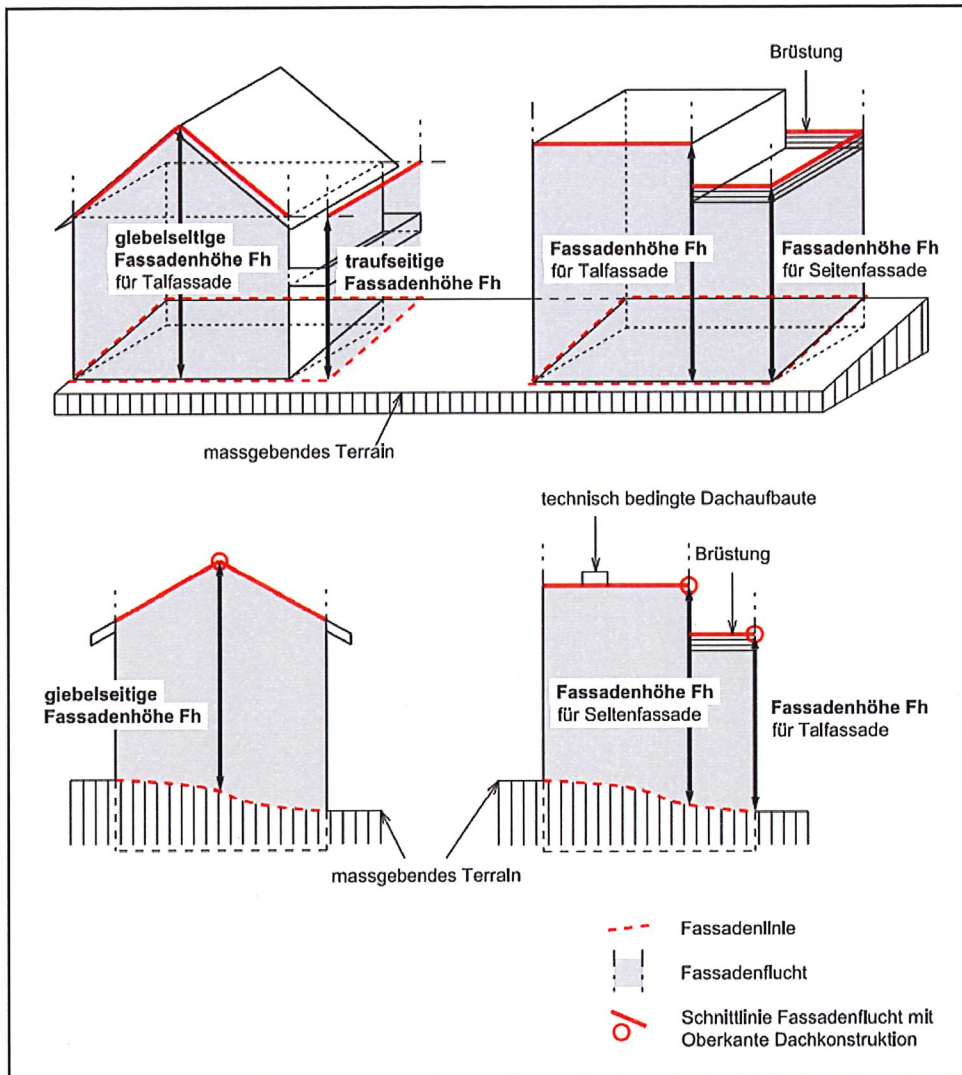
Schema Fassadenhöhe gemäss § 278 PBG
